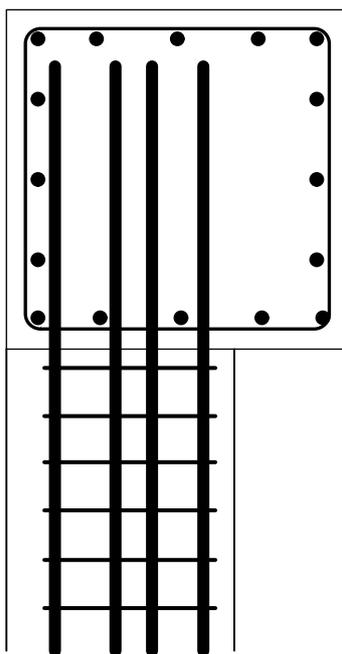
RC 梁與 RC 柱偏心接合平面圖
